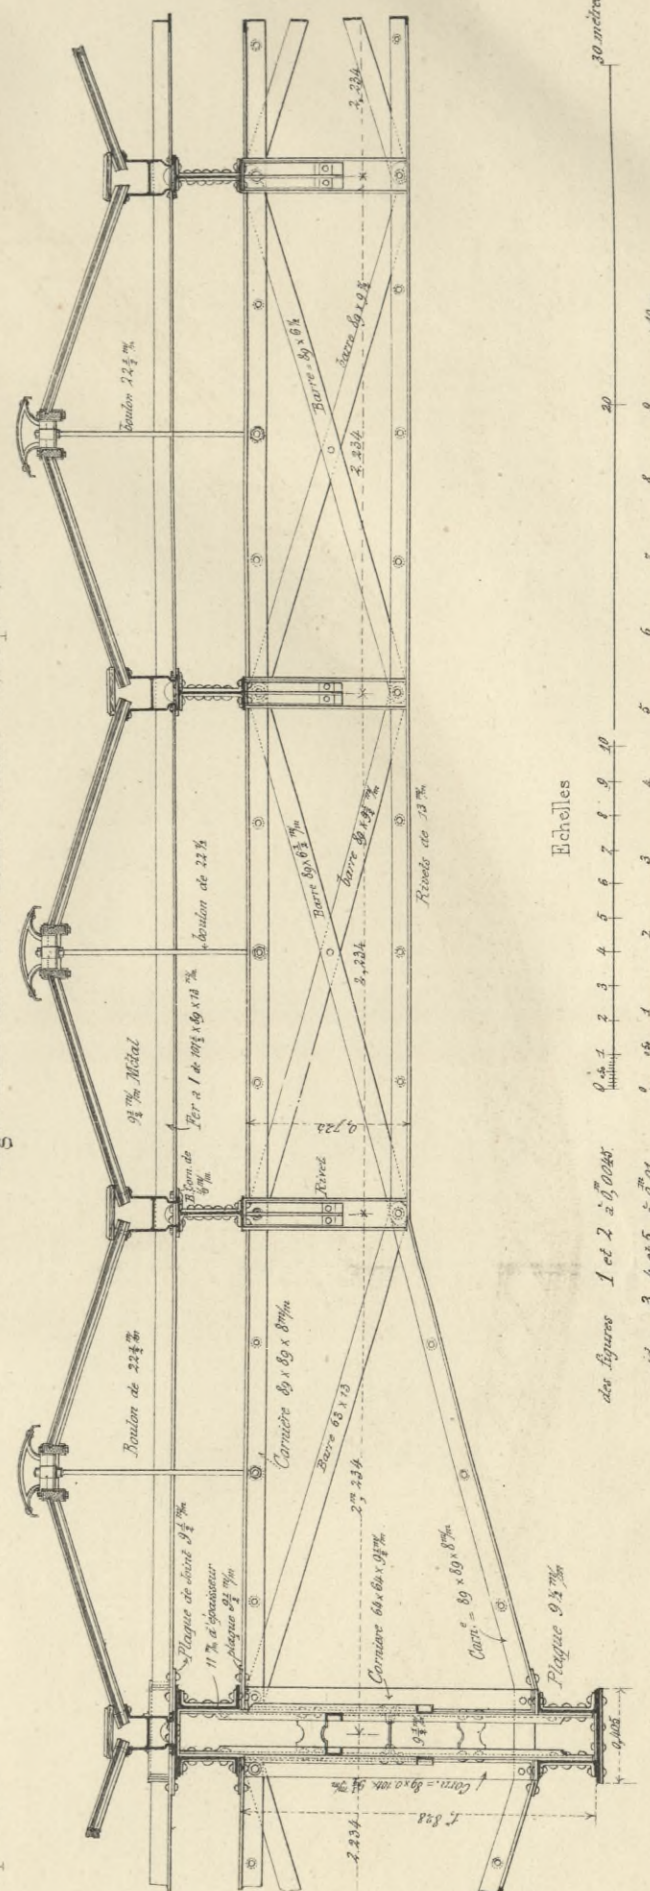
Elevation de la Poutre Fatigue à 0,001 pour 1,00
